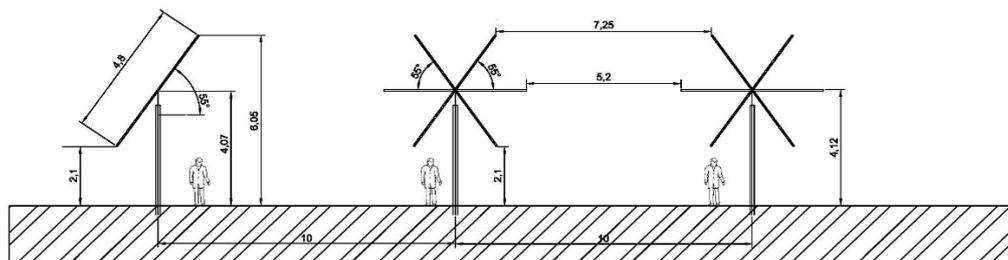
Quote e distanze dal suolo delle strutture ad inseguimento (tracker)
